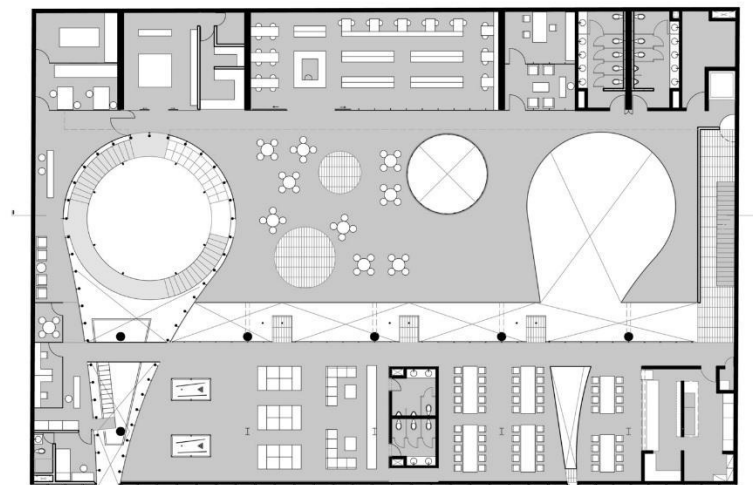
Estación de Bomberos Ave Fénix. Plano de segunda planta
